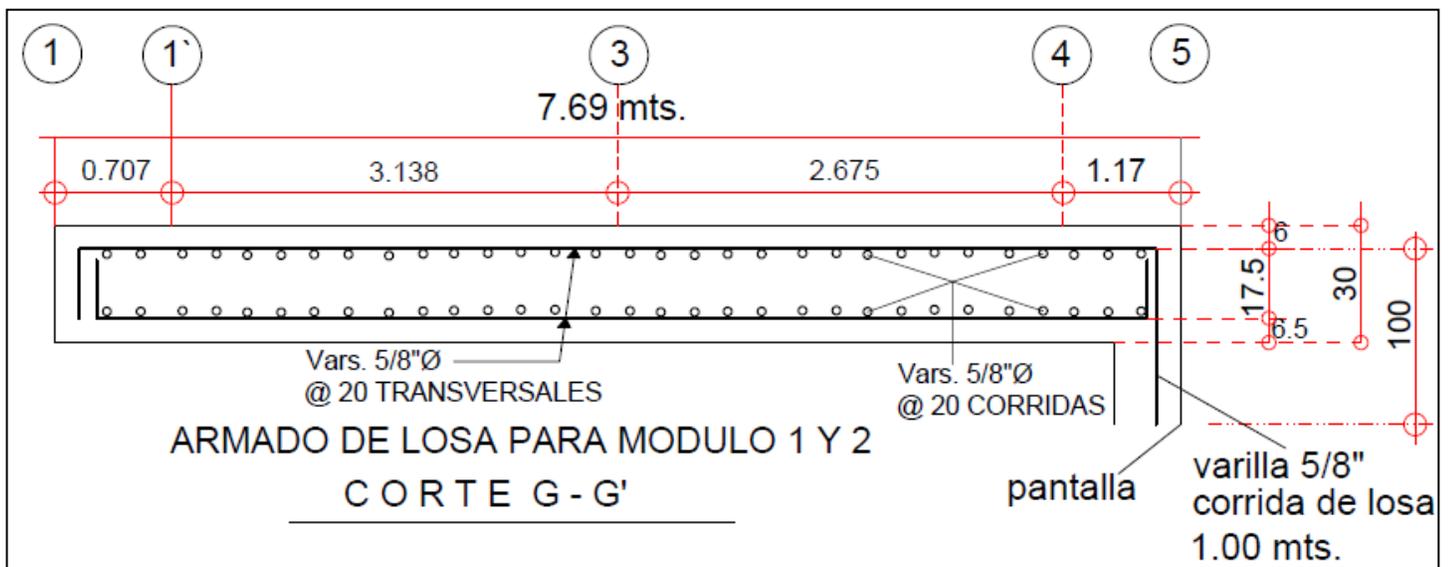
Vista frontal de pantalla y armado de losa en los módulos 1 y 2.
